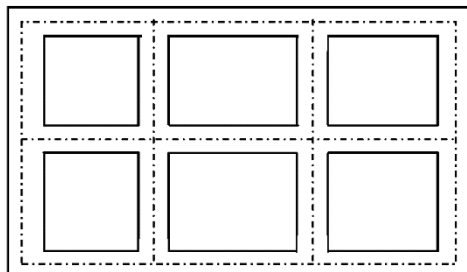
Sistema reticular de vigas de cimentación en sistema de muros portantes.
